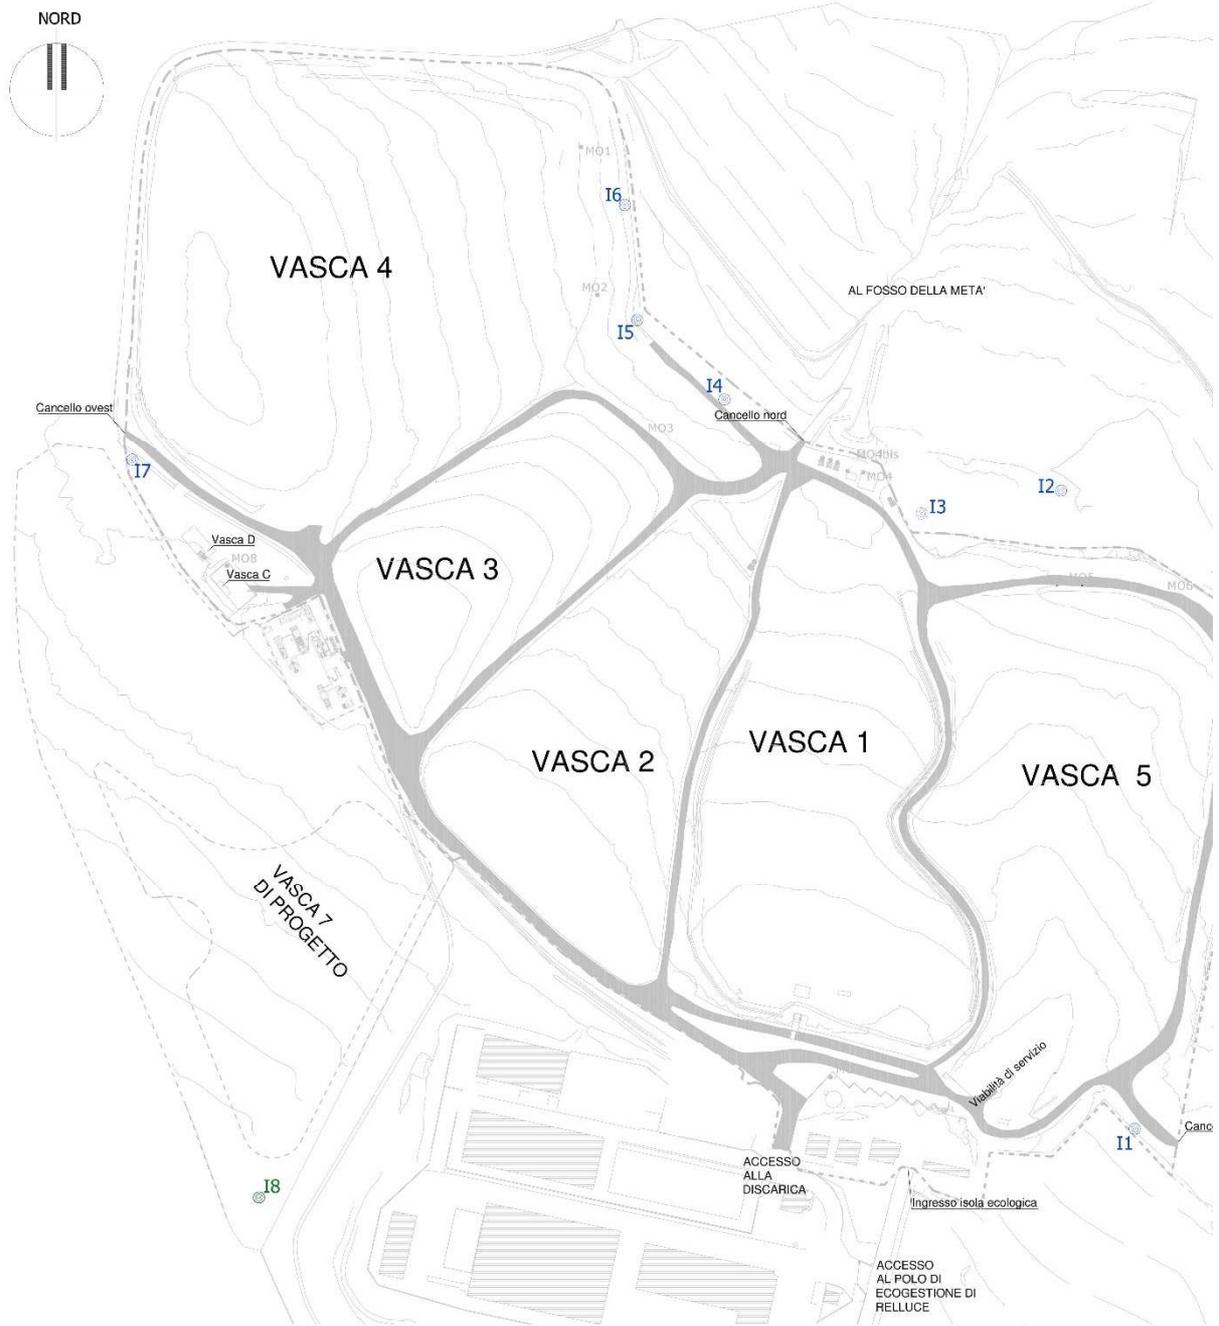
Stralcio planimetrico dei punti di monitoraggio della stabilità (inclinometri)
